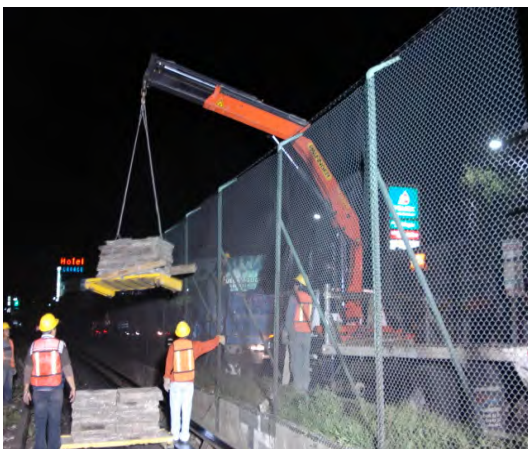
Retiro de placas de concreto reforzado con grúa de 10 ton.
